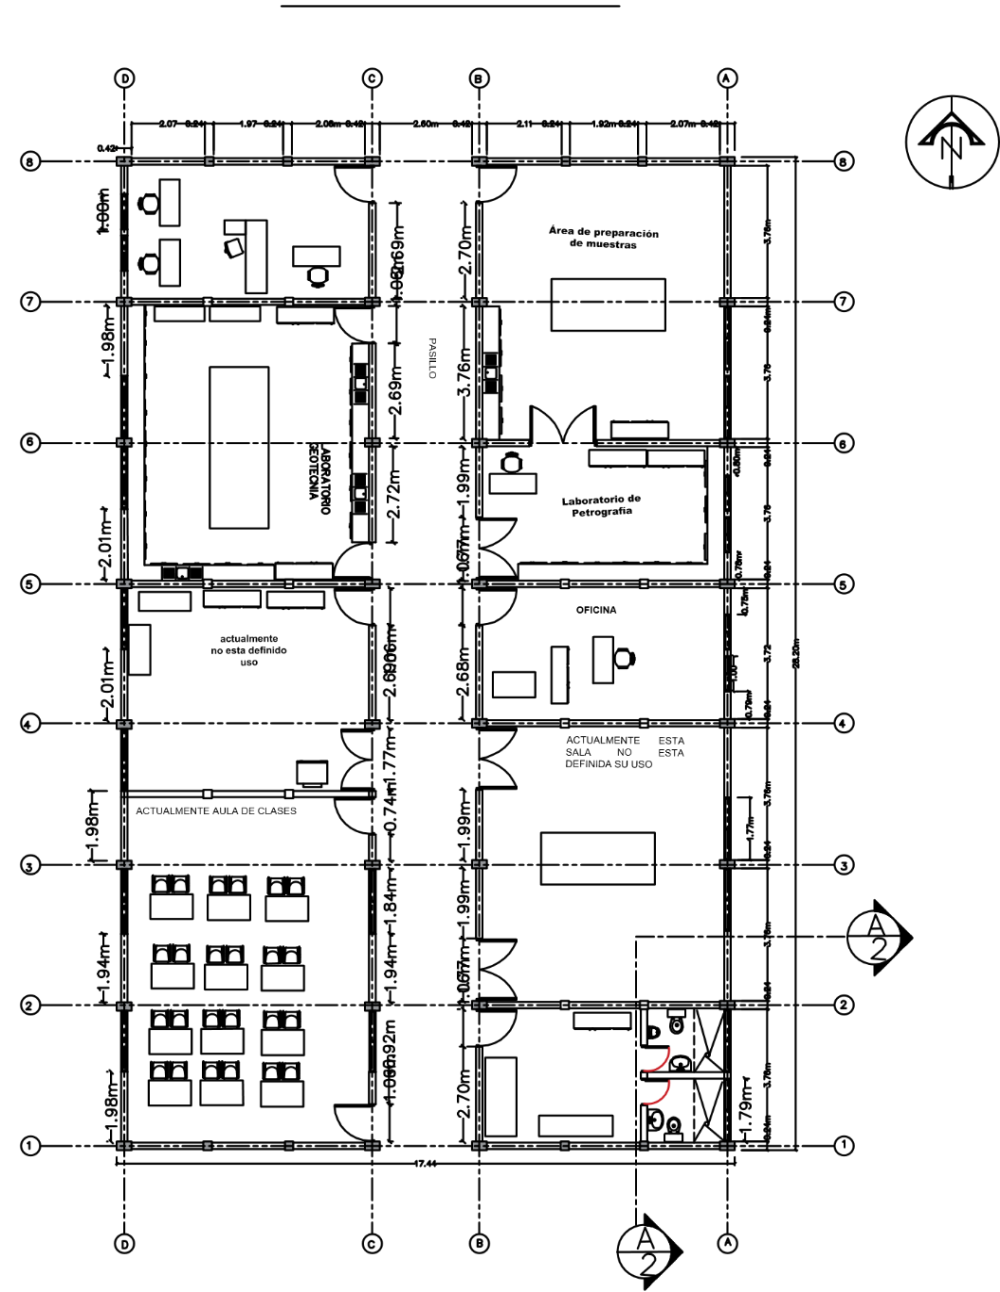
Planta arquitectónica actual del Laboratorio
